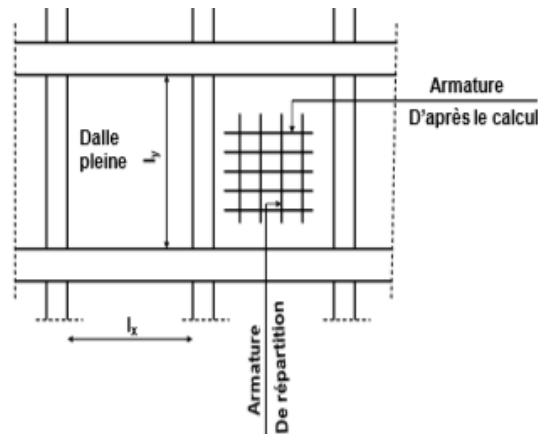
disposition du ferrailage d'une dalle qui travaille dans un seul sens
